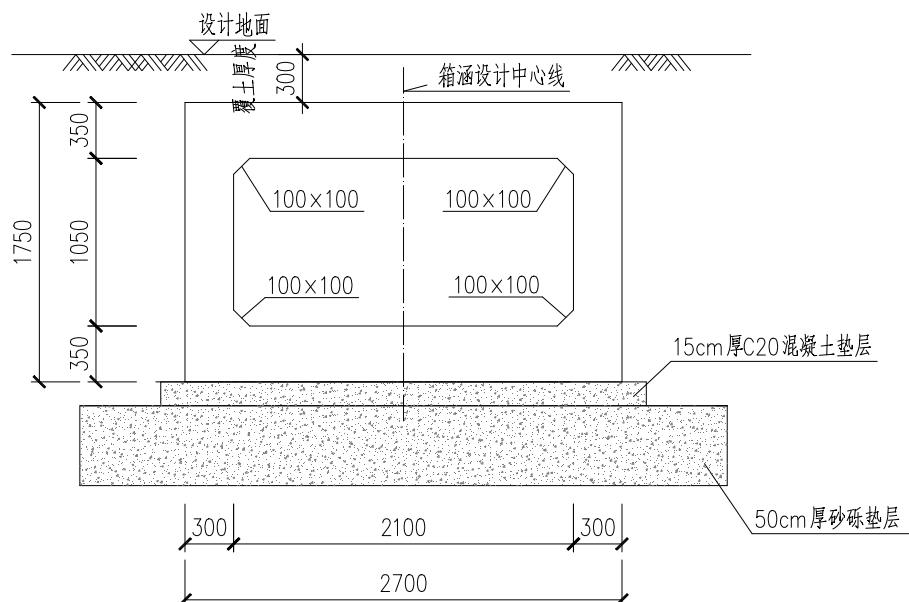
接长更合大道箱涵横断面图 (单位: mm)
